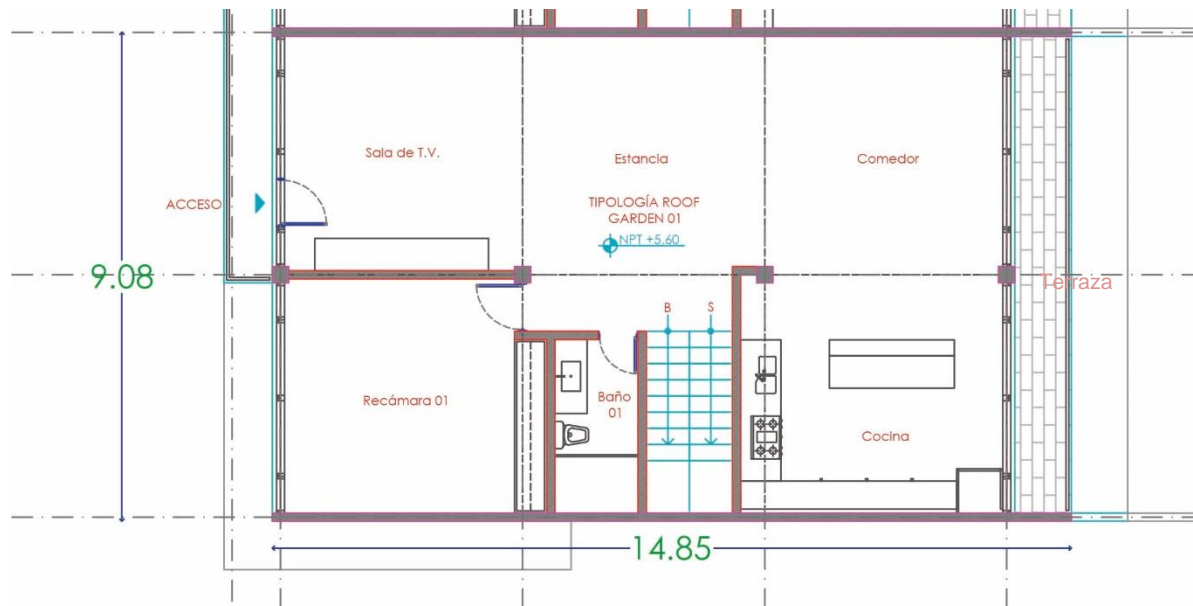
Se muestran los compartimentos de la Villa Roof Garden tipo 1 en planta alta.
